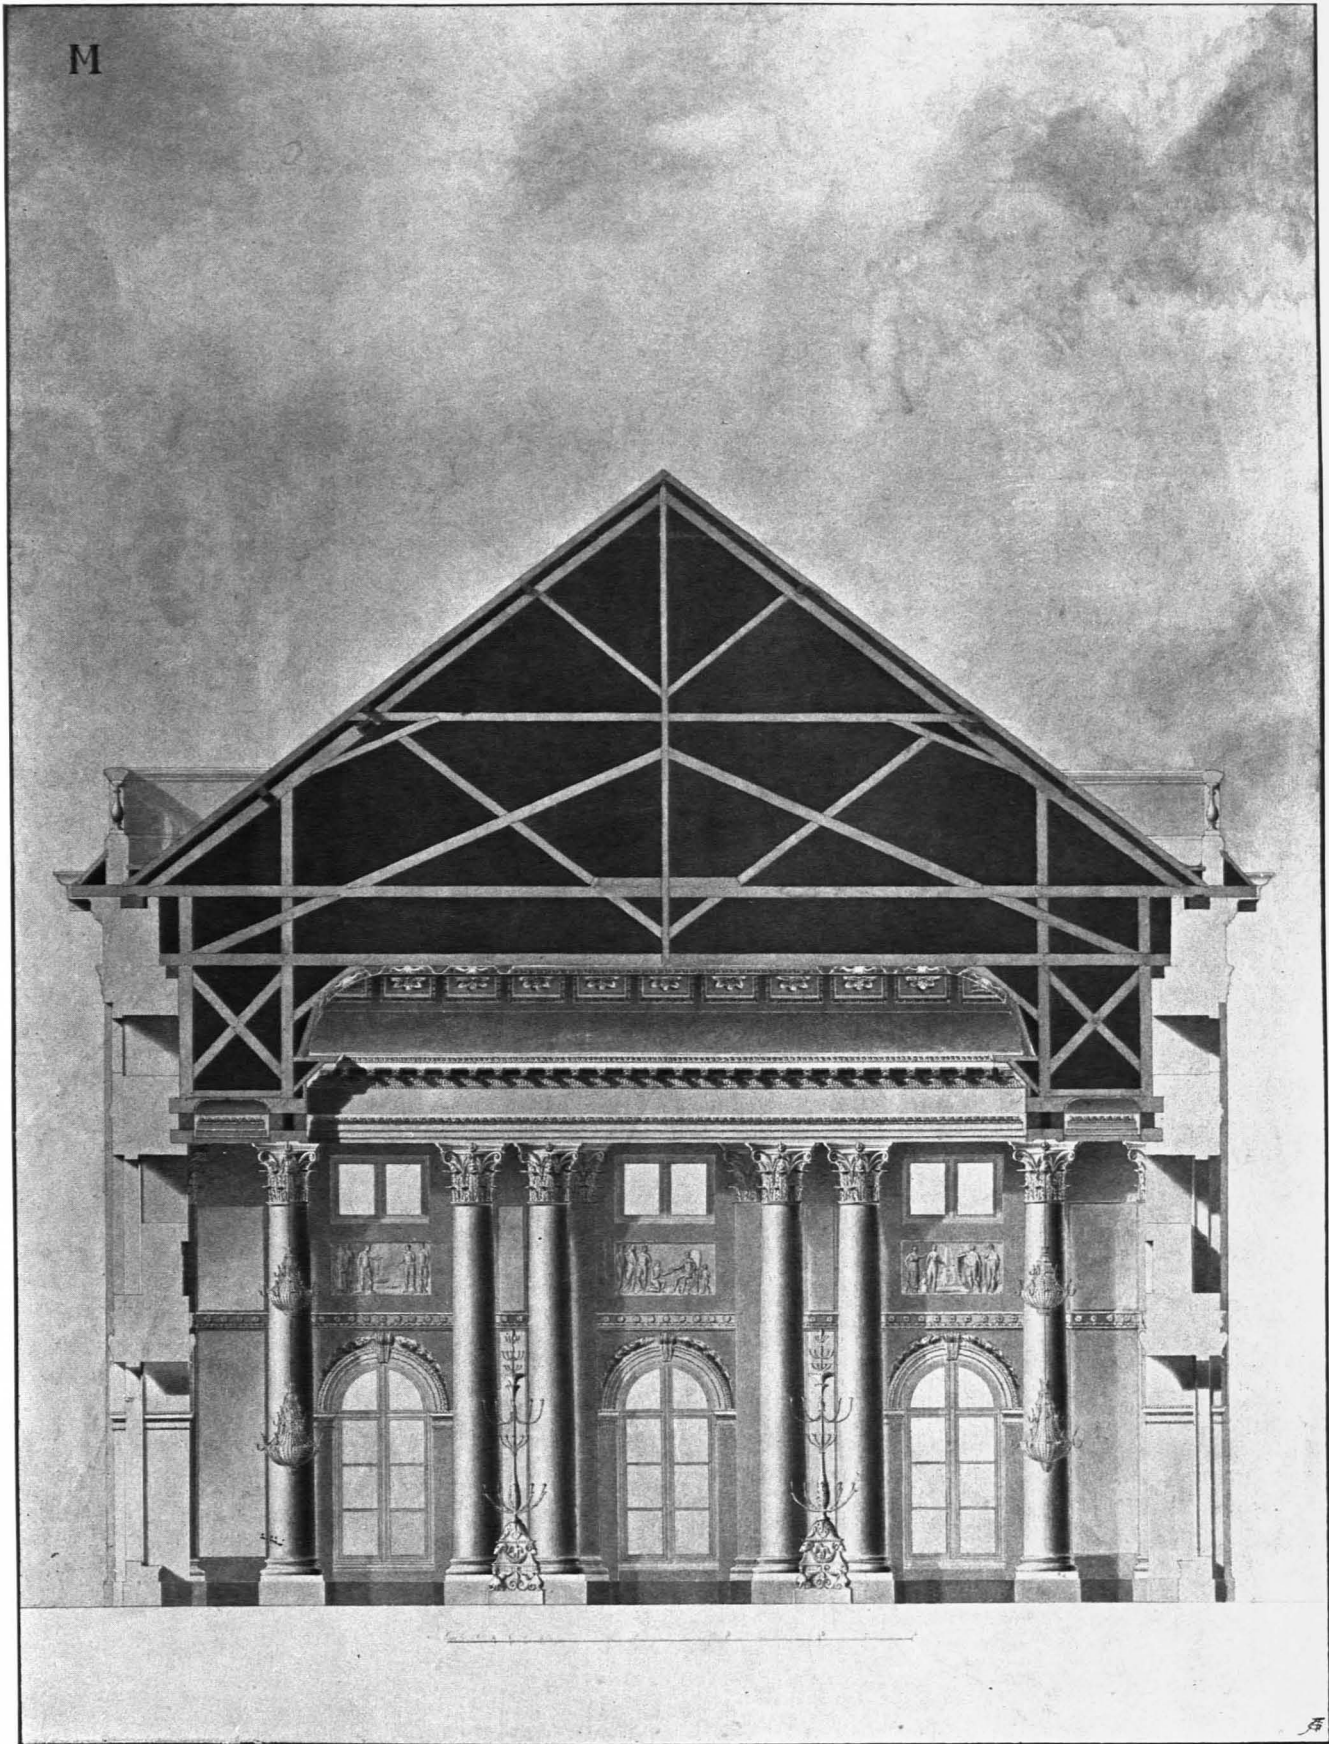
Querschnitt durch den „Rittersaal“, lavierte Federzeichnung von L. Montoyer,
